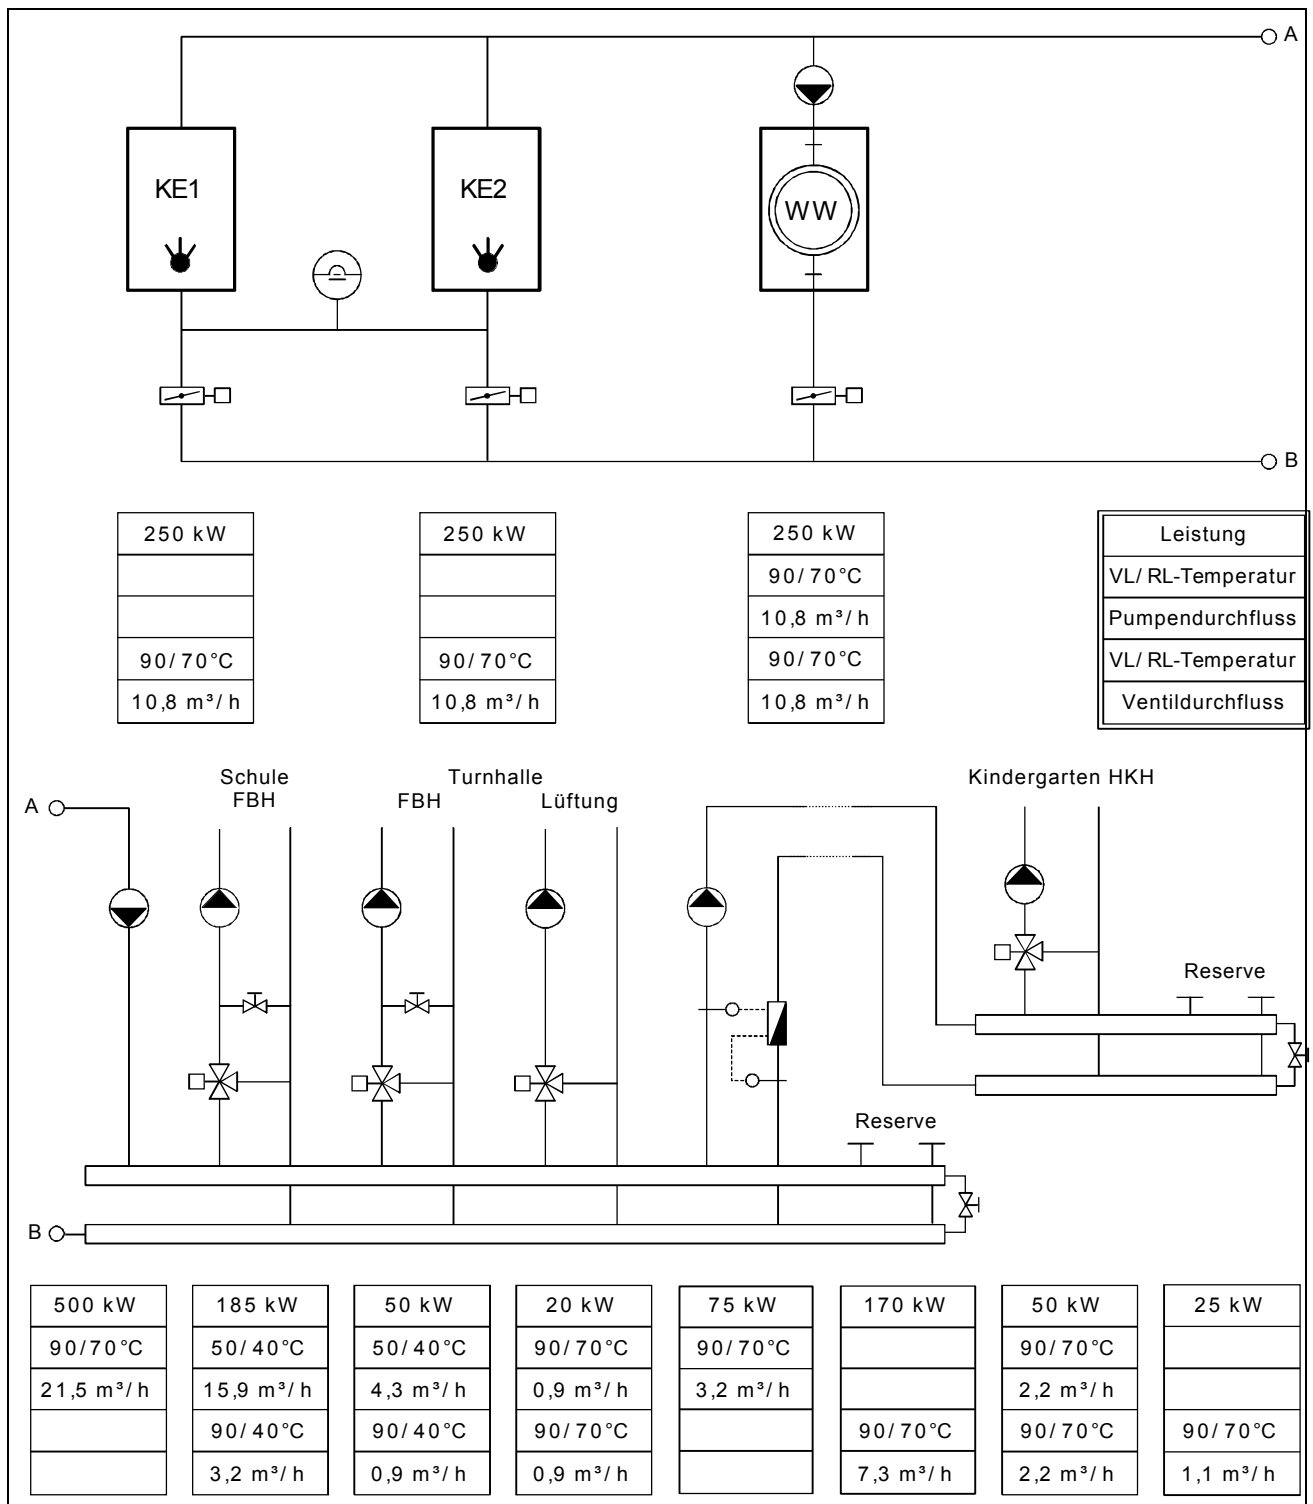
Prinzipschema der bestehenden Heizungsanlage
